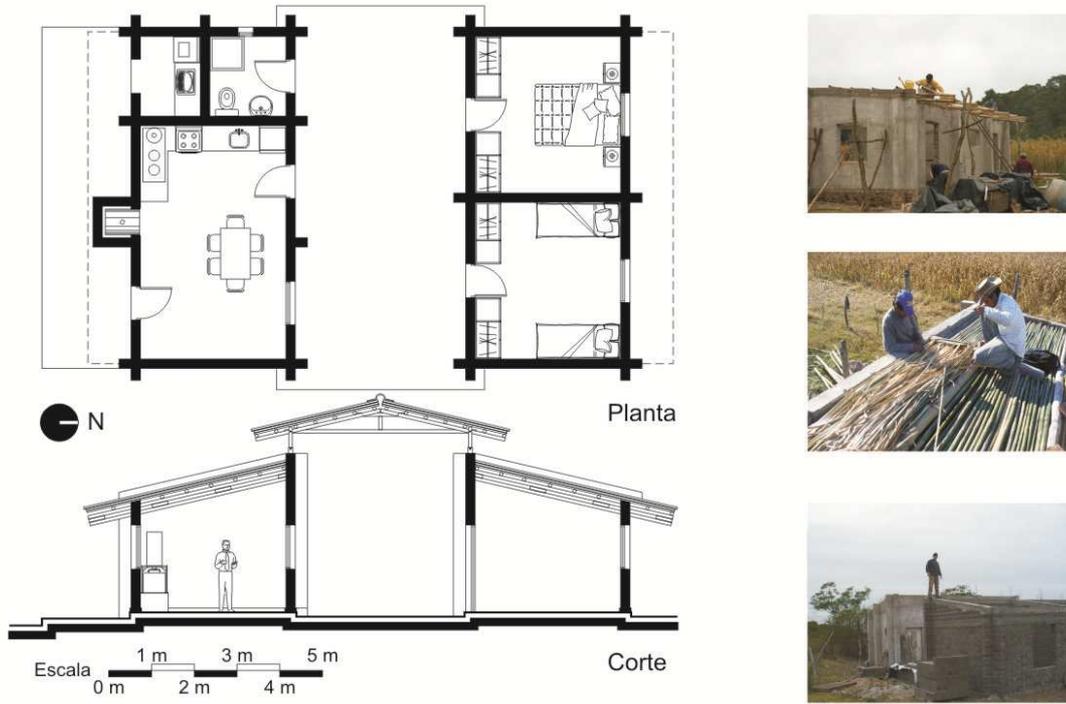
A la izquierda: Planimetría general de la vivienda diseñada. A la derecha: Construcción de un prototipo piloto en el área estudiada.
